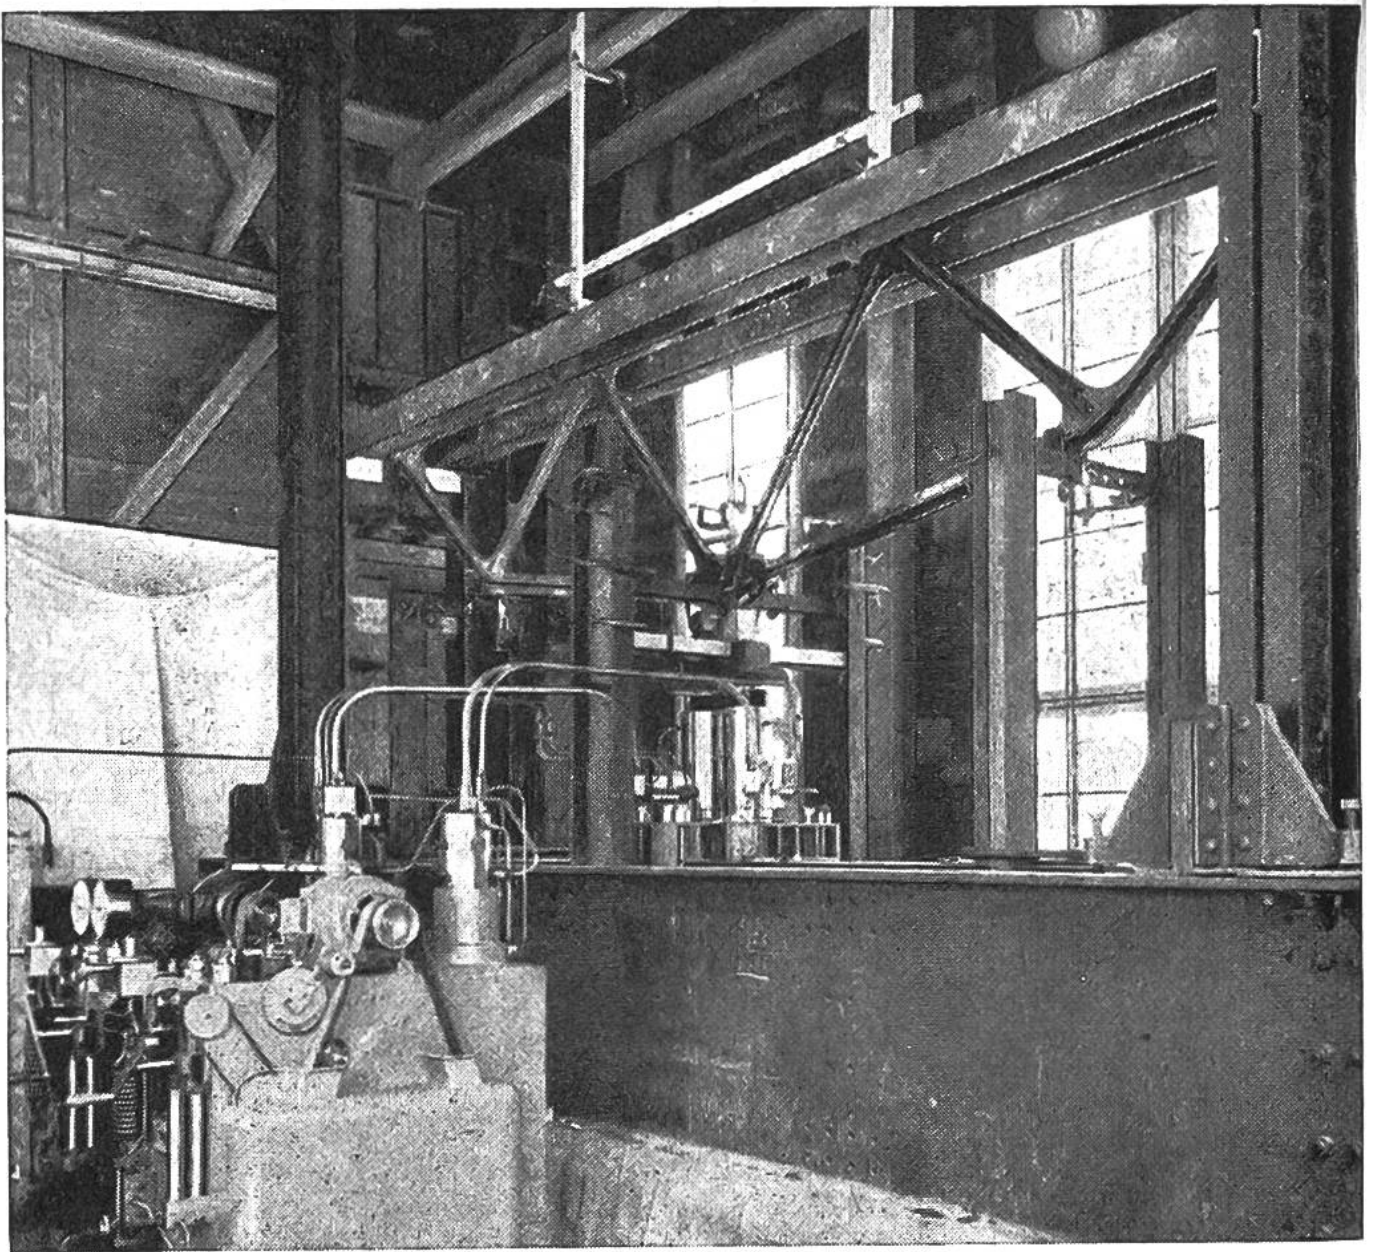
Ein geschweisster Fachwerkträger als Modell einer Stahlbrücke wird einem Ermüdungsversuch unterworfen. Links ist die Pulsatormaschine mit den daran angeschlossenen auf- und niedergehenden Kolben sichtbar.
